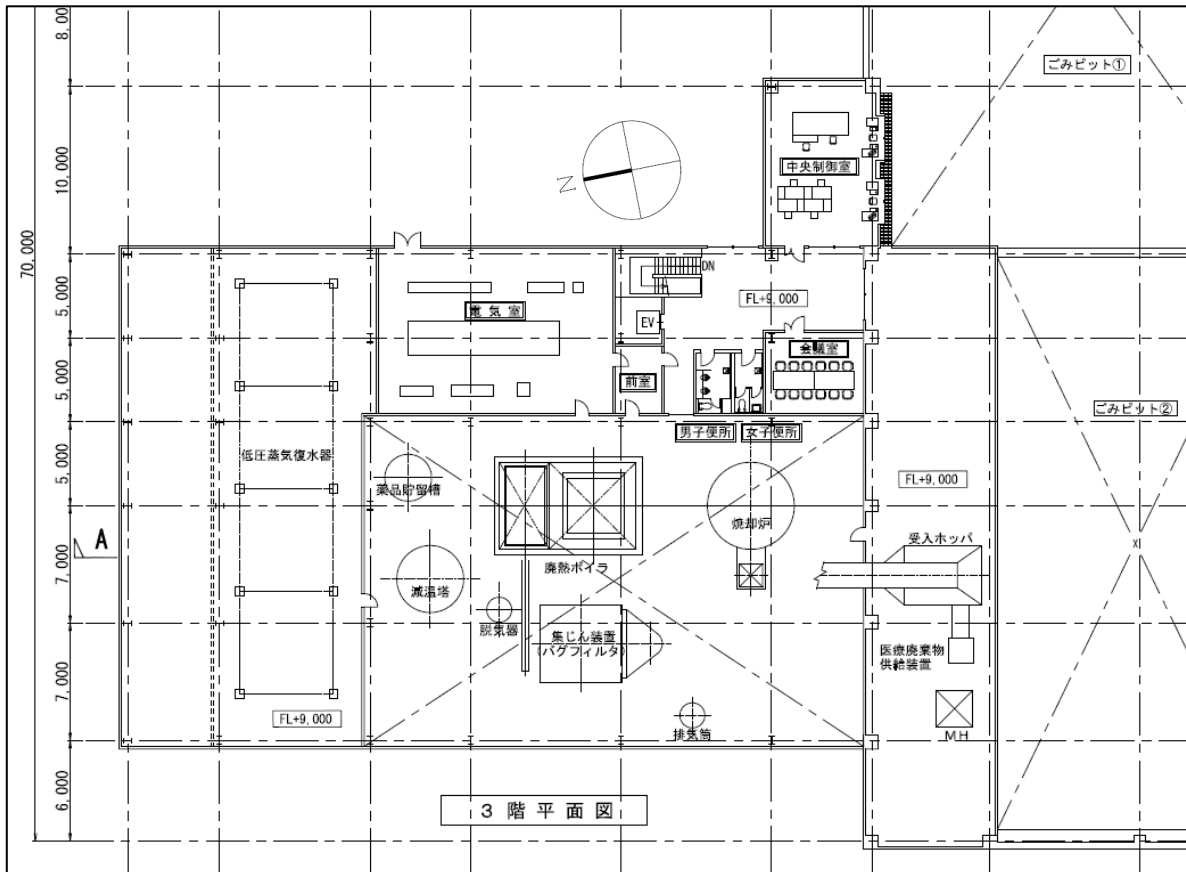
(3) 設備配置図 (焼却施設 3階)
